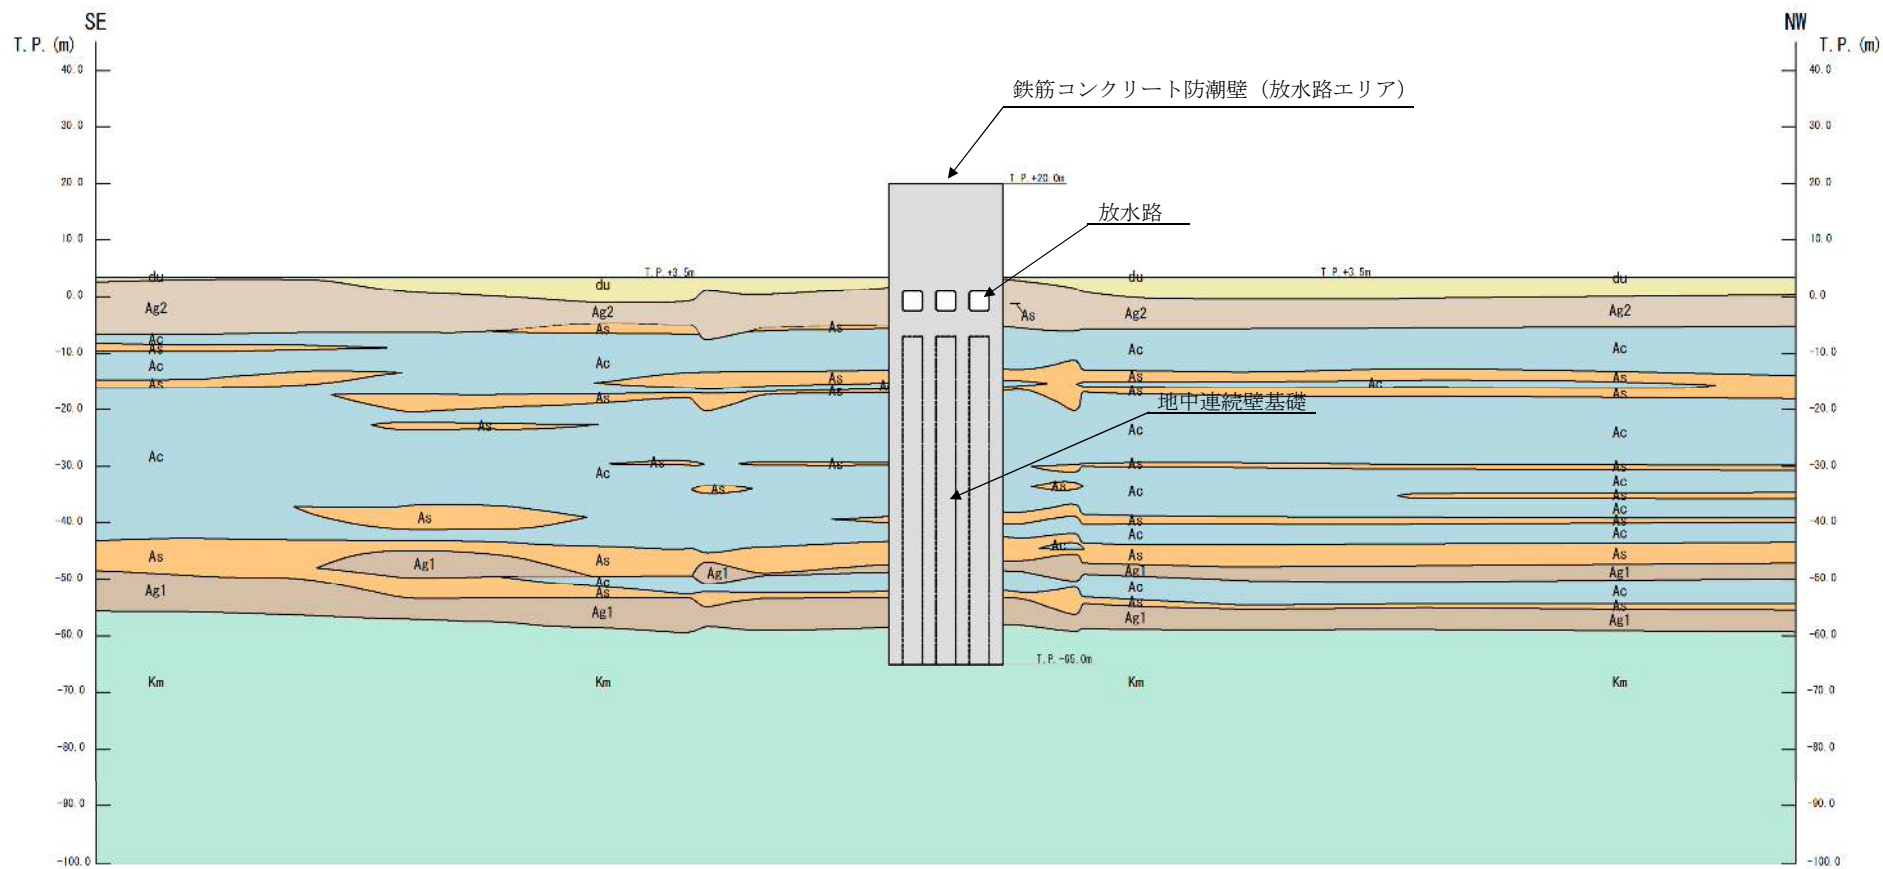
(2) 鉄筋コンクリート防潮壁（放水路エリア）の評価対象断面図（防潮壁縦断方向：②-②断面，防潮壁部）
